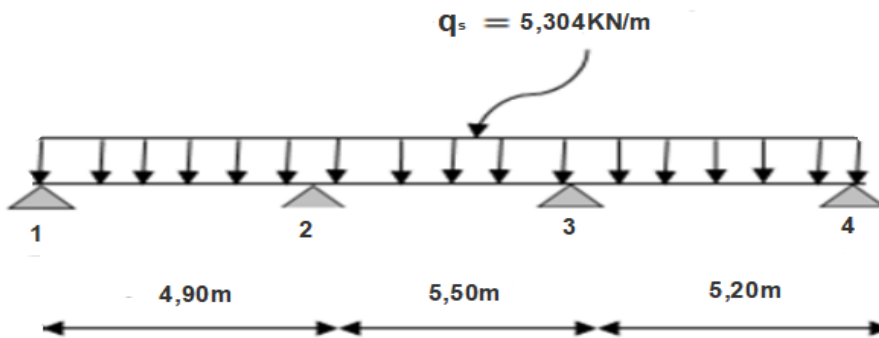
schéma statique de la poutre continue reposant sur quatre appuis.
